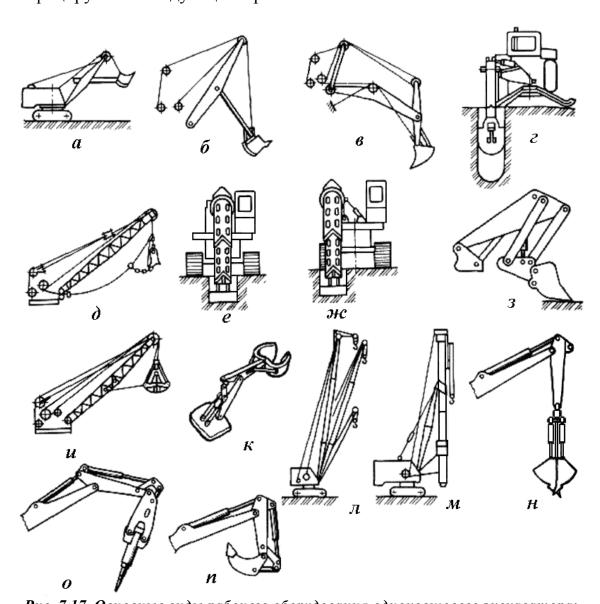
Основные виды рабочего оборудования одноковшового экскаватора: a – прямая лопата с принудительным напором; b – маятниковая прямая лопата; b – обратная лопата; c – боковая обратная лопата; d – драглайн; e – планировочное телескопическое оборудование; m – боковое телескопическое оборудование; m – погрузочное оборудование; m – грейфер на канатной подвеске; m – челюстной захват; m – кран; m – копер; m – грейфер на жесткой подвеске; m – молот; m – рыхлитель
